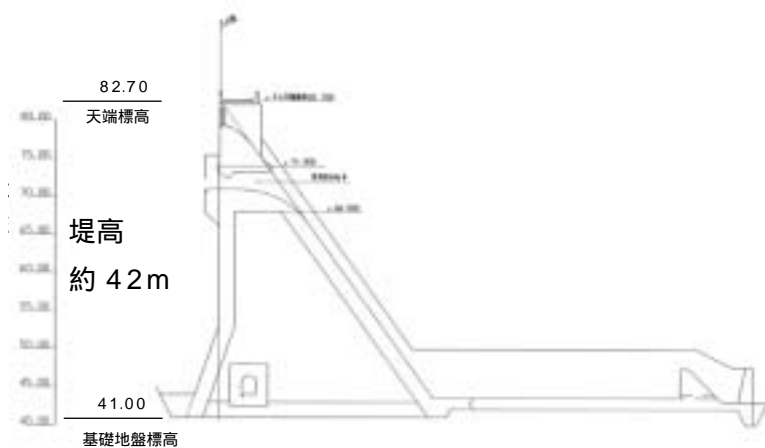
3 伊木カダム標準断面図 (S = 1:1,000)
